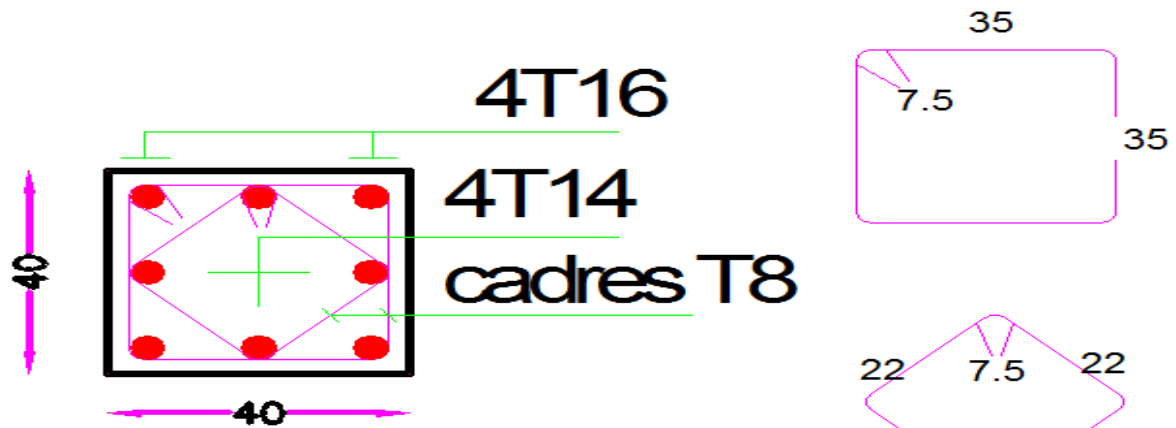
Schéma de ferrailage du poteau RDC + S-Sol.
